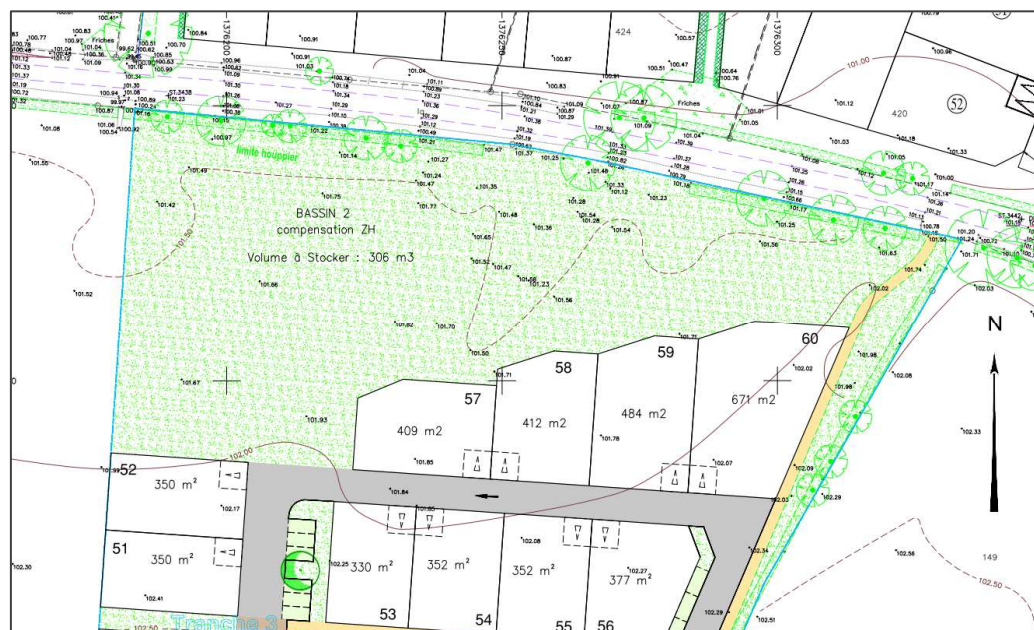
Partie Nord du plan de composition retenu pour le futur aménagement (GEOUEST, 2021)
